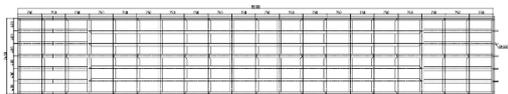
Design Layout Konstruksi Slopeway Desain 1
